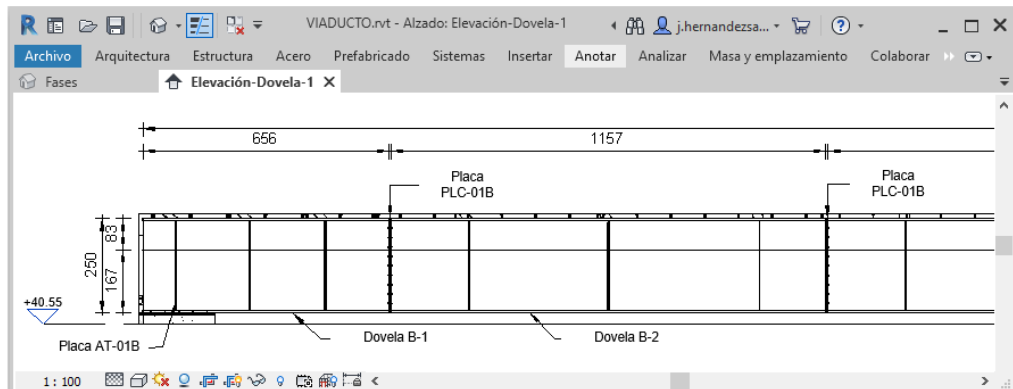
Elevación estructural con anotaciones. Fuente: Elaboración propia
